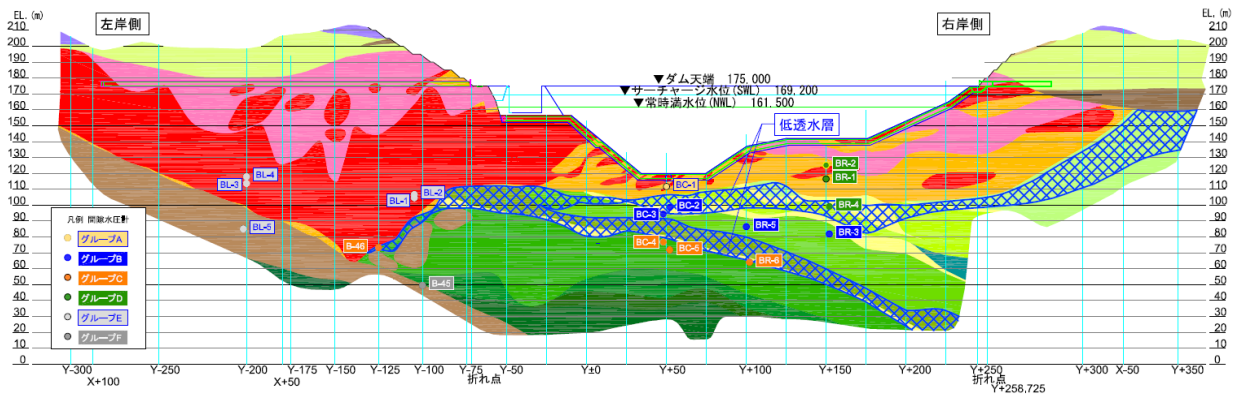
ダム軸縦断面図と地質図および岩盤間隙水圧計の設置状況
